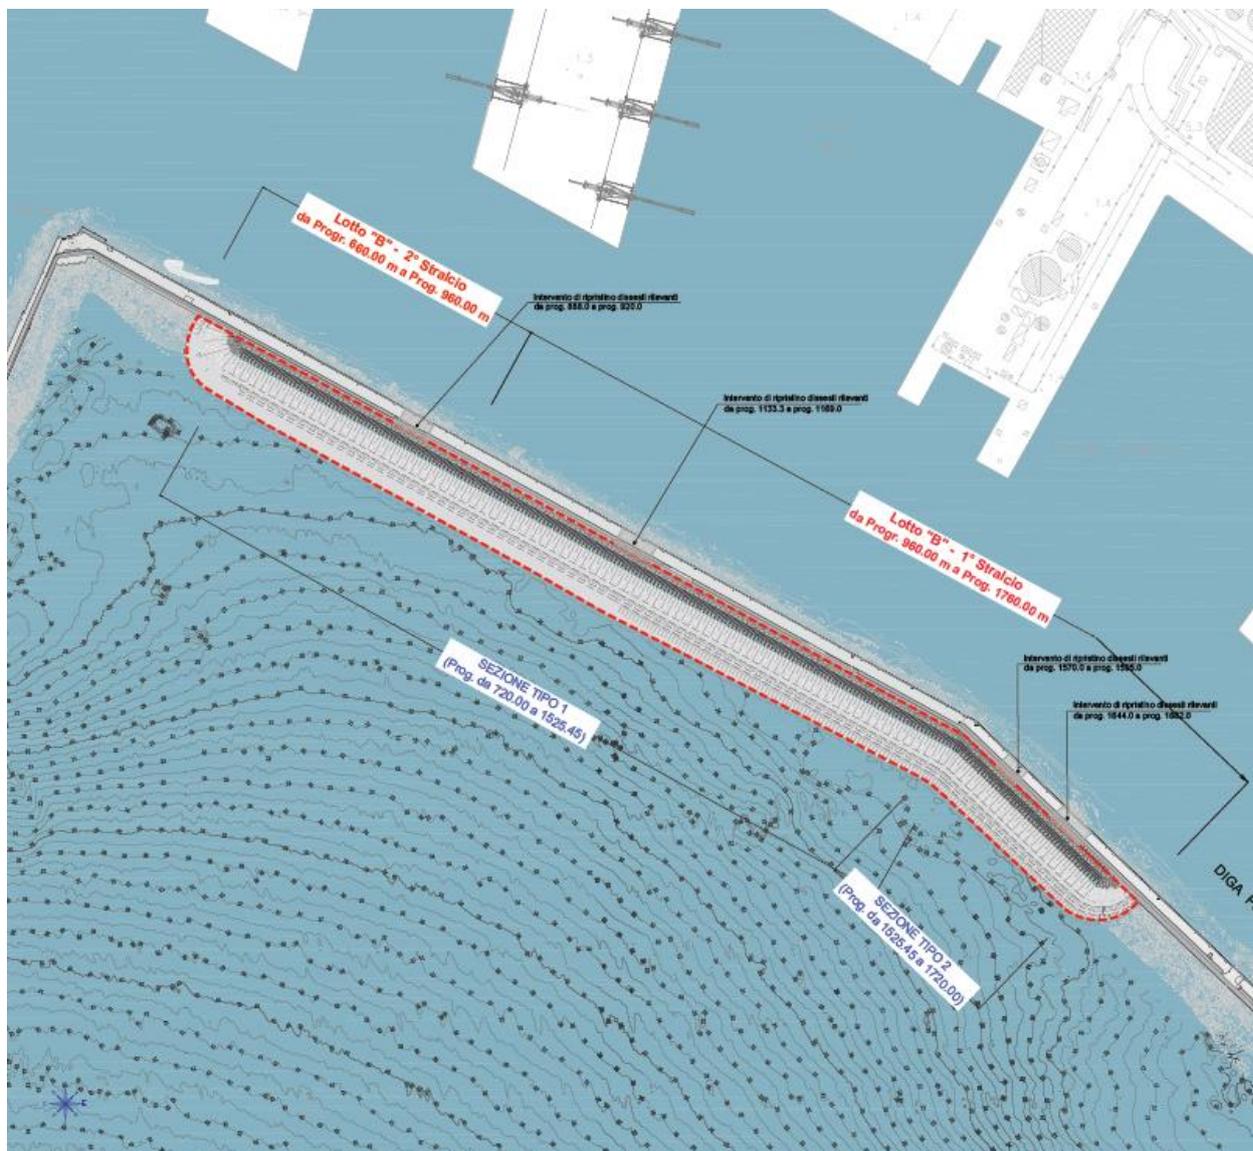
Planimetria di progetto opere I stralcio 800 m (PNRR) – opere di II stralcio 300 m (completamento)
